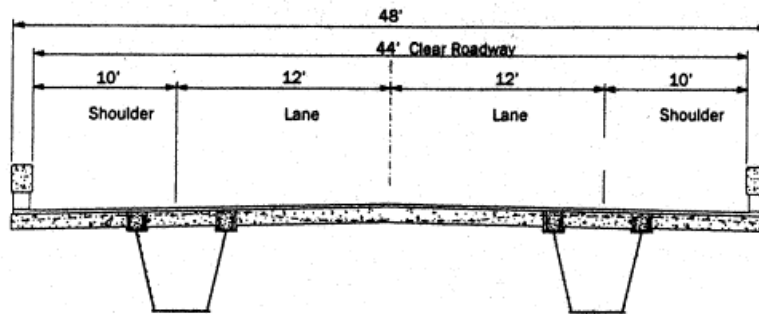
coupe transversale du Pont Snyder-Nebraska
